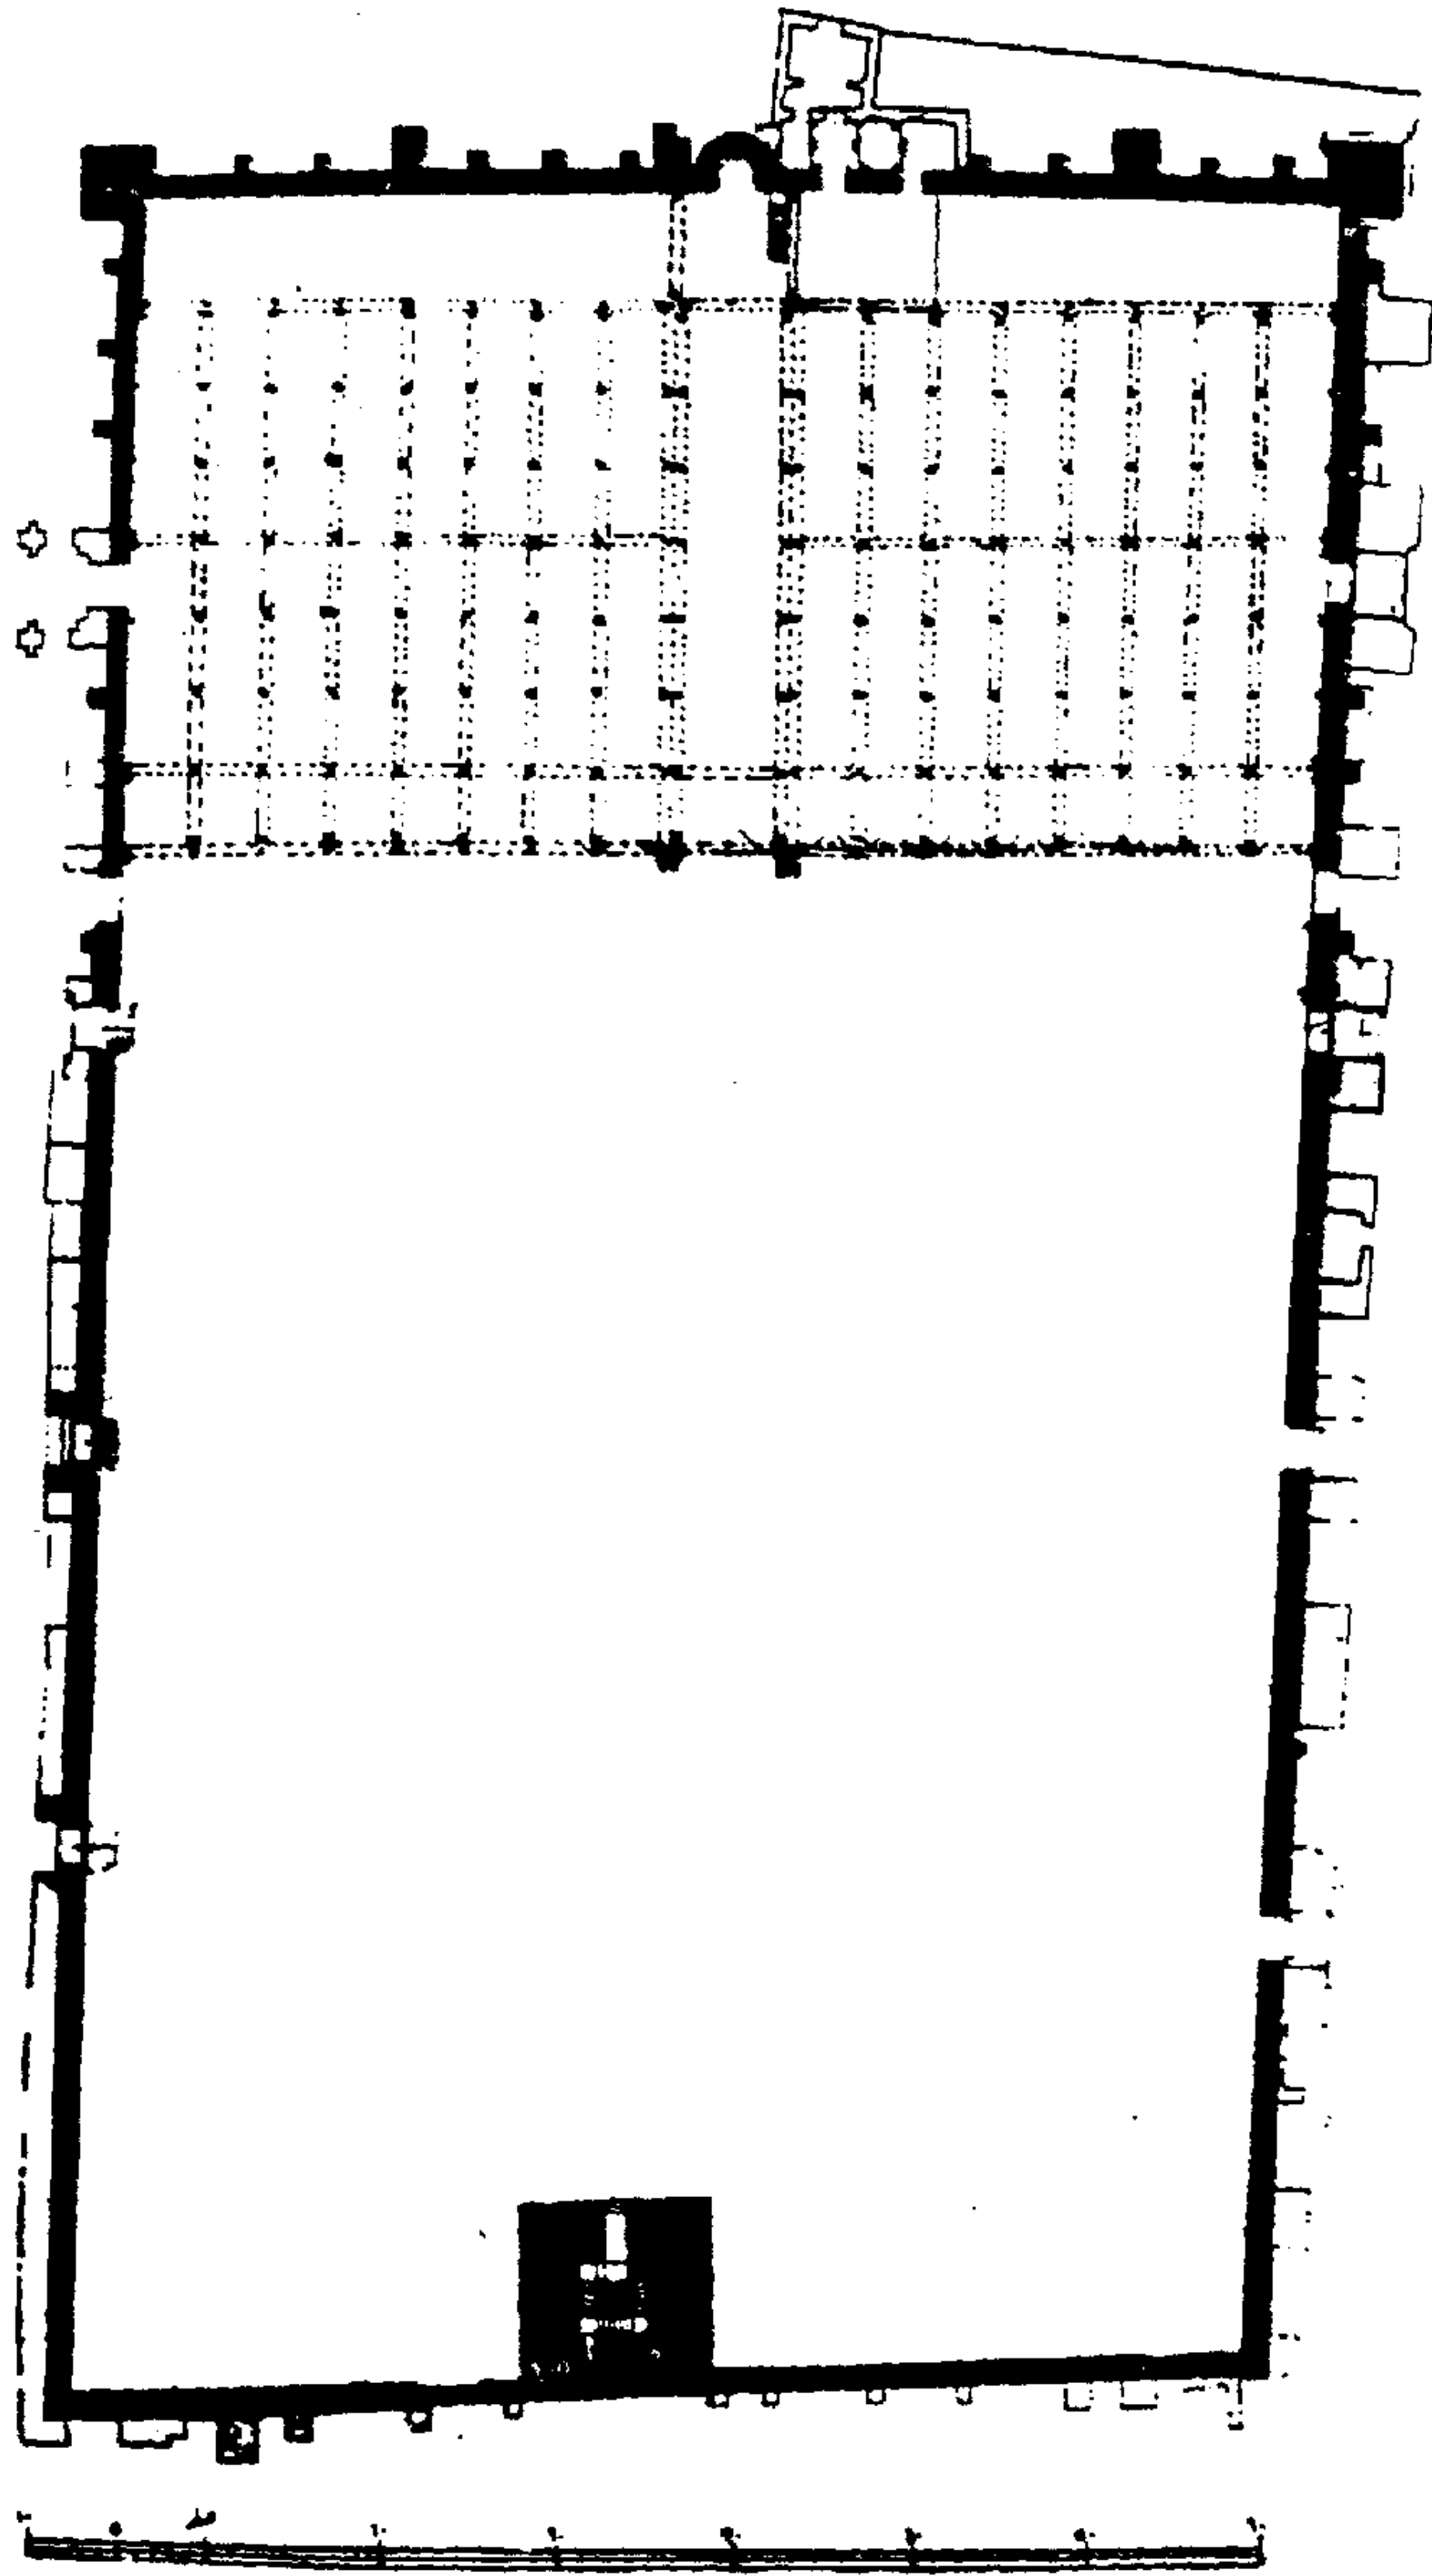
مسقط أفقي لجامع ابن صوان عن الموسوعة (الجزء الأول).
